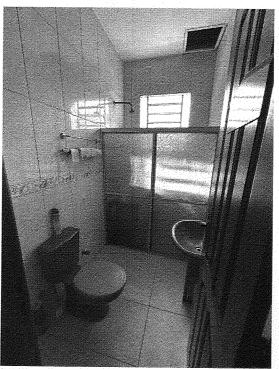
Banheiro Social 1º Pavimento. Fonte: Autor.
